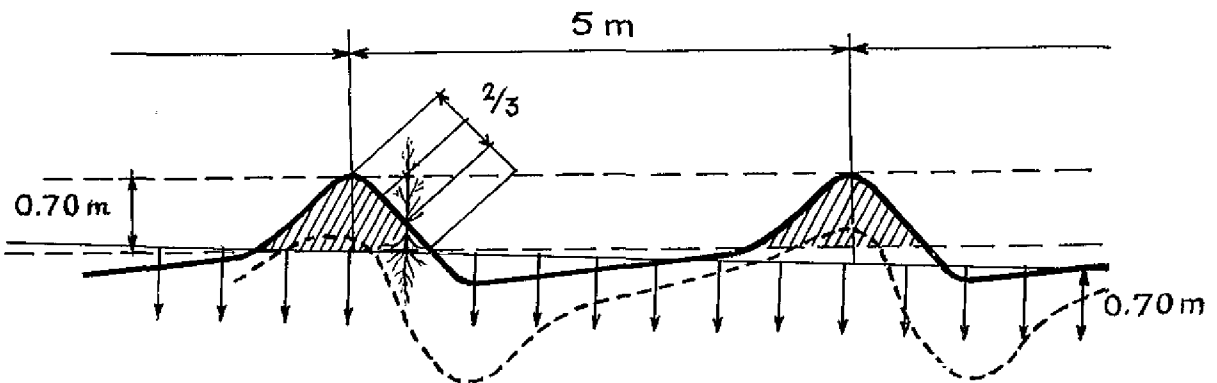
Le plant situé aux $2/3$ du bourrelet n'est pas déchaussé.
